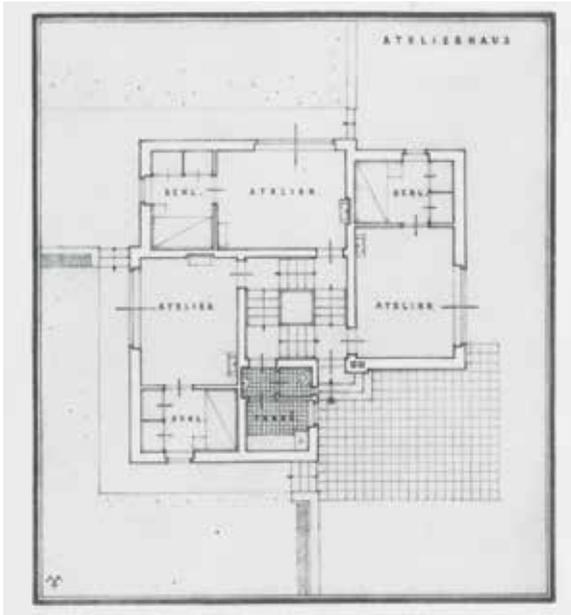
Fréd Forbát, Entwurf für ein Atelierhaus der Bauhaussiedlung, 1922, ArkDes Collection, Stockholm.
